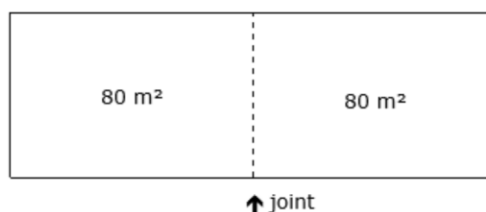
Fractionnement de la chape en cas de plancher chauffant
